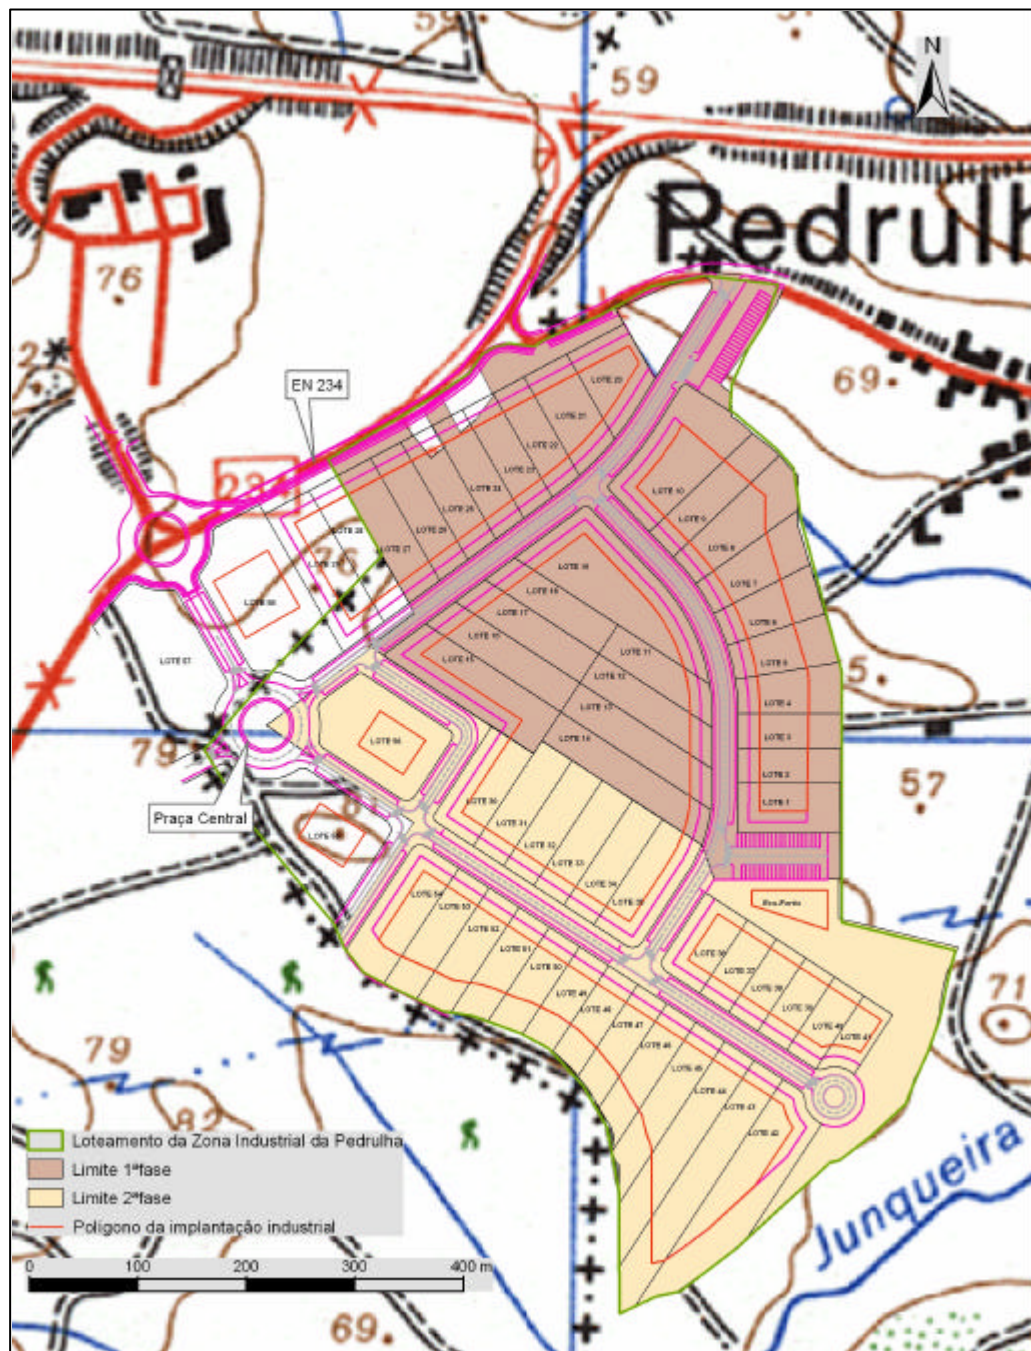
Planta do loteamento da zona industrial da Pedrulha
